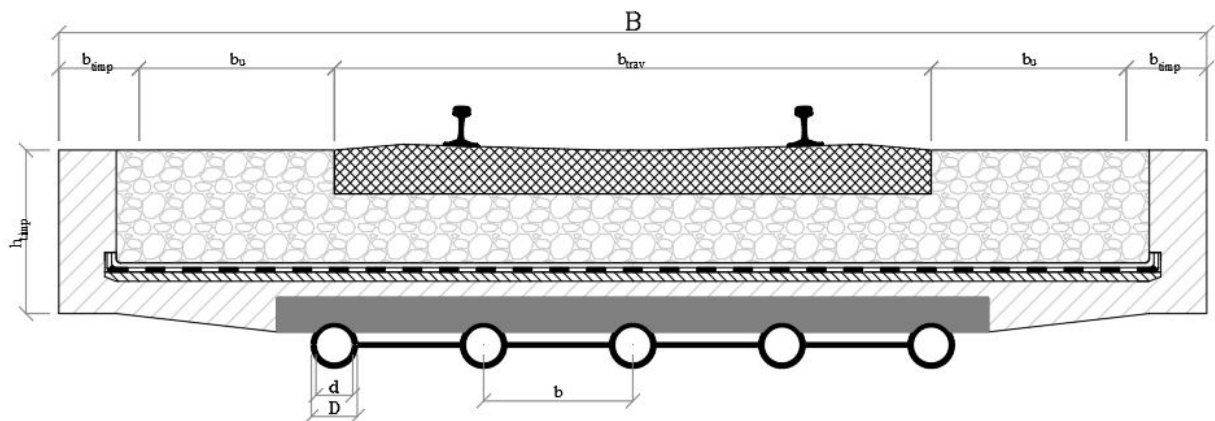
2 – Secțiune transversală dală cu secțiune mixtă oțel-beton – structura metalică din țevi distanțate
